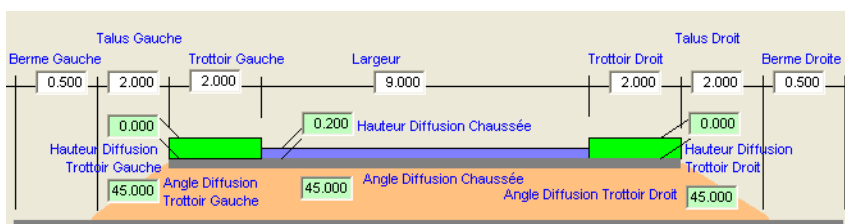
Profil provisoire de l'ouvrage avec remblai
